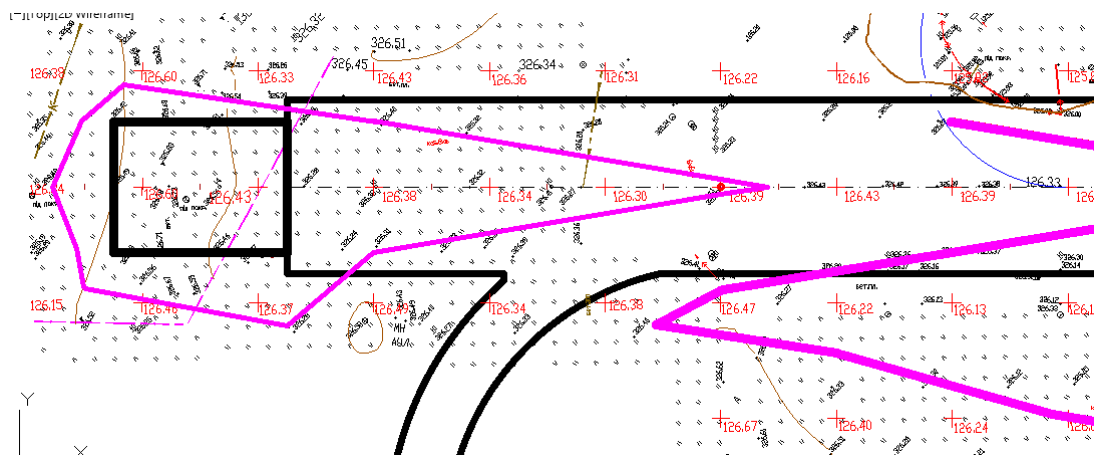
Фрагмент плану вертикального планування аеропорту Житомир
